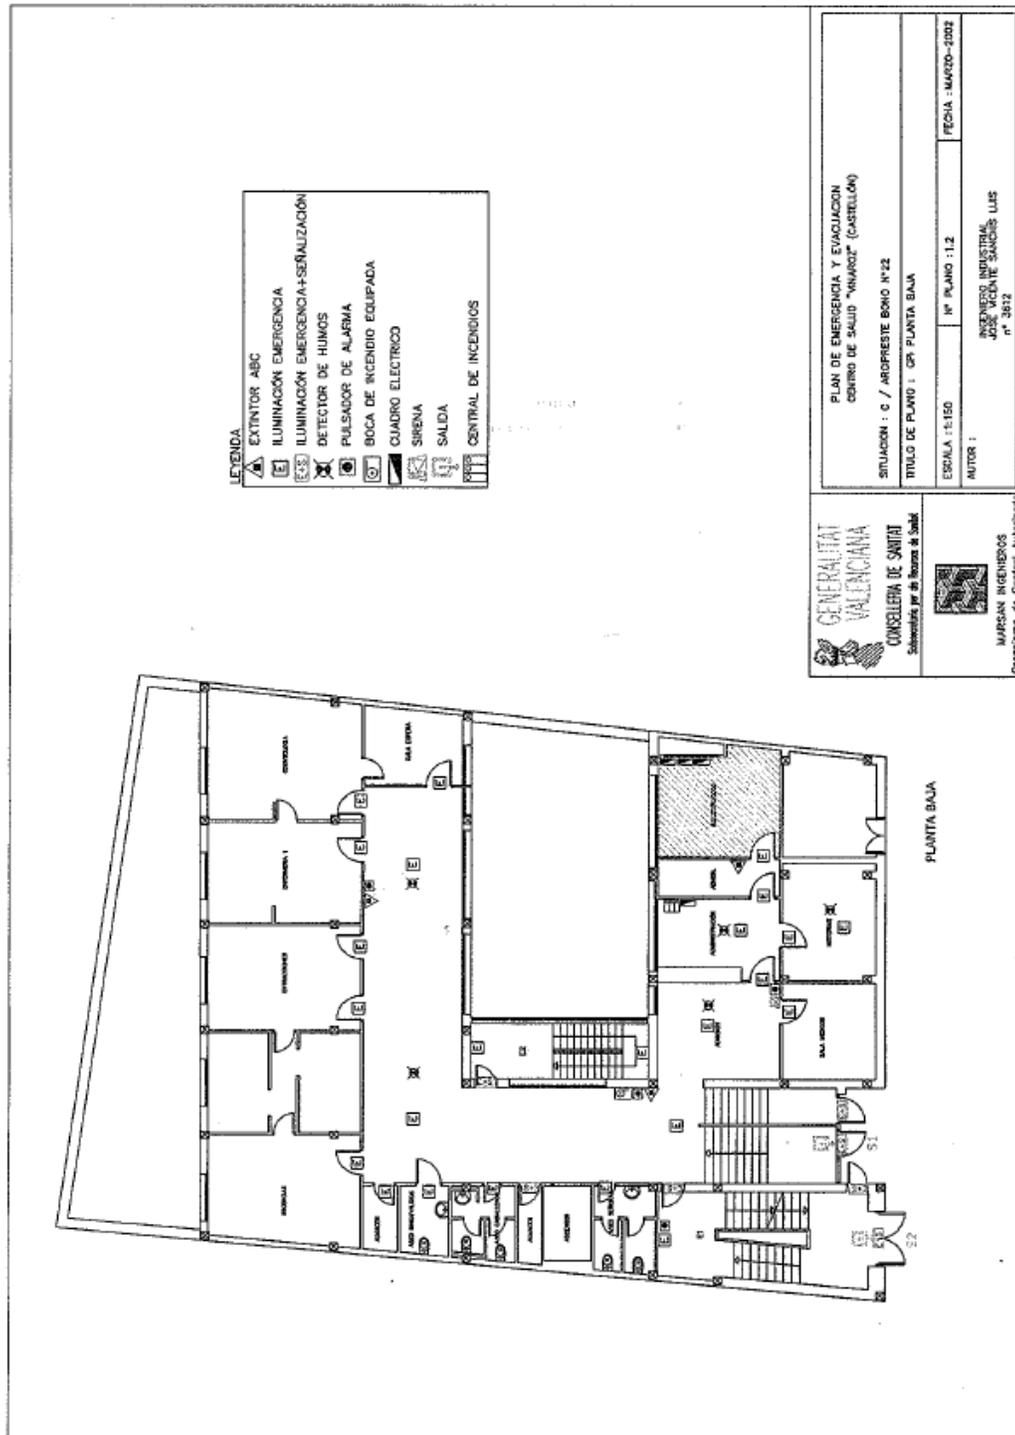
Esquema planta baja del centro de salud de Vinaroz.
